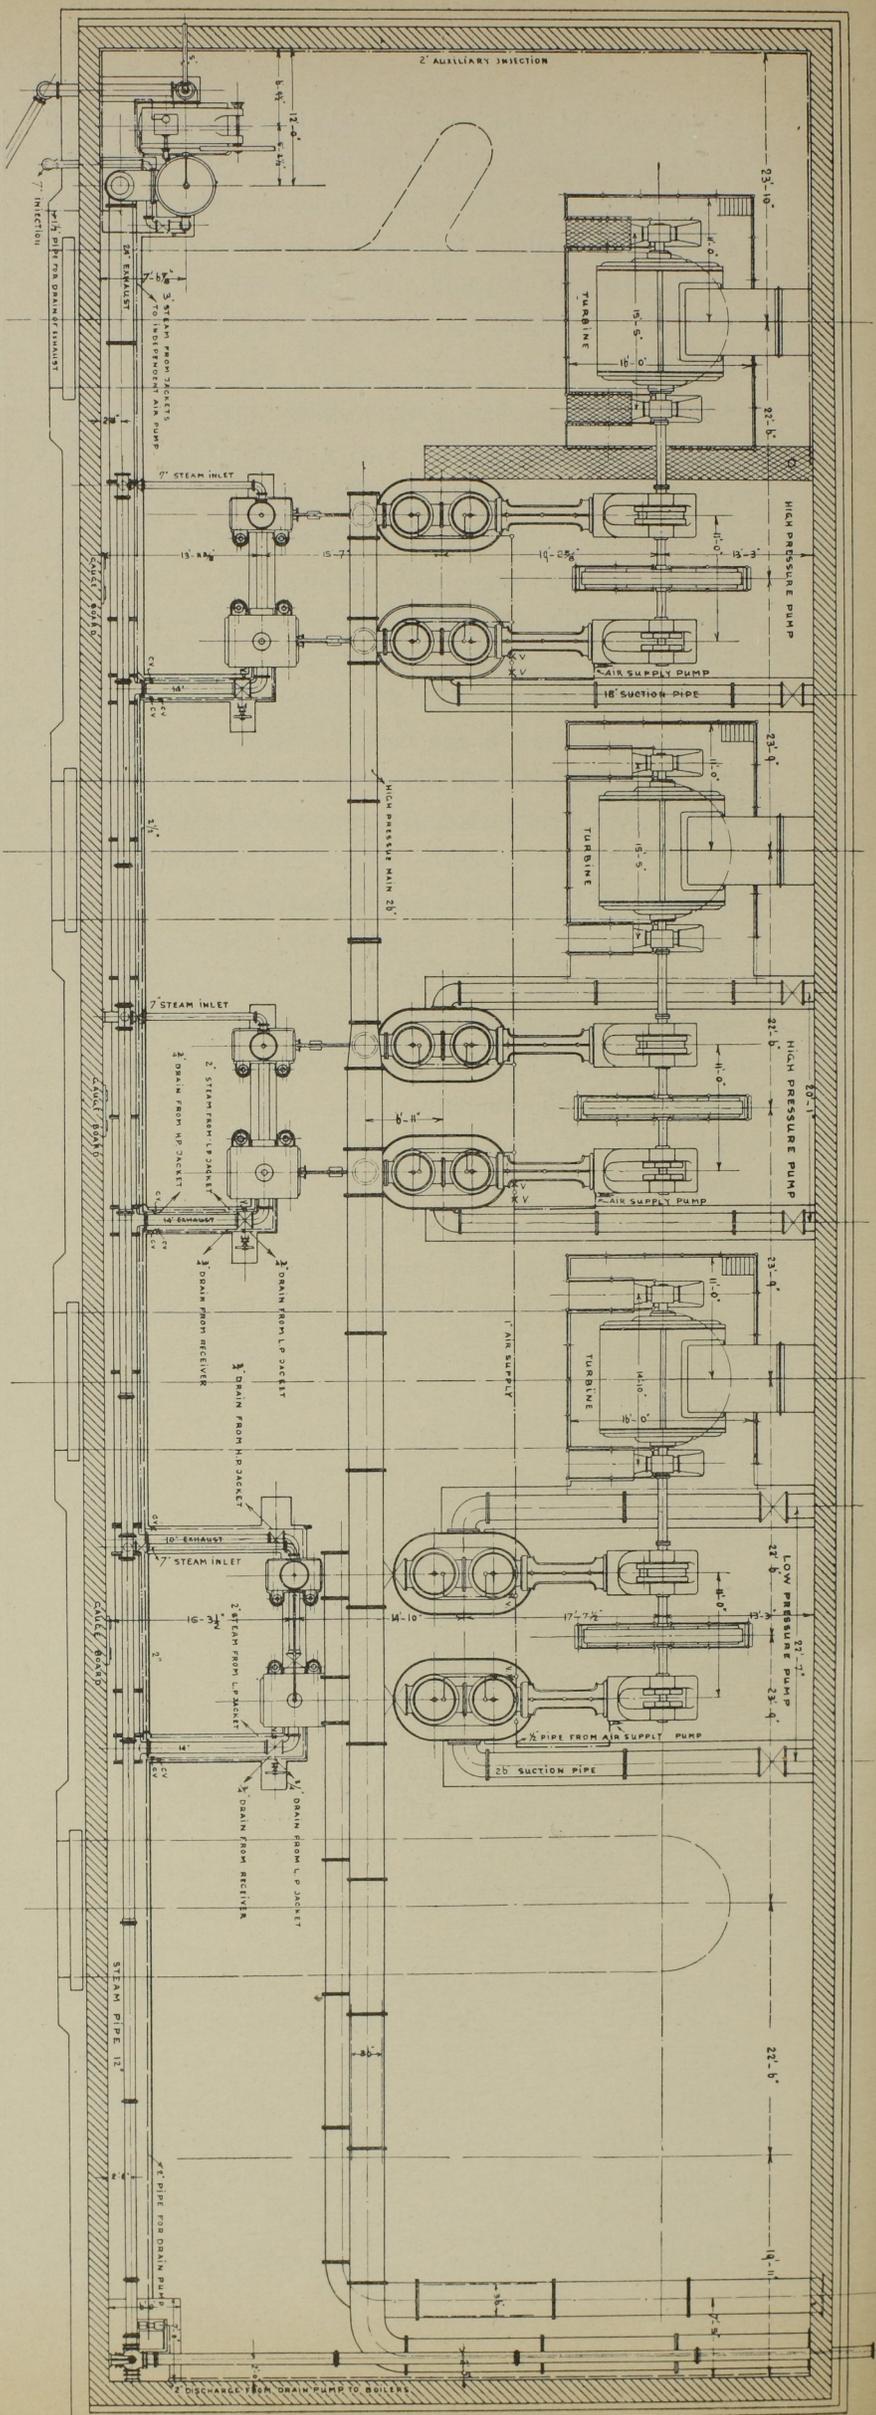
Grundriss. Abb. 175 Aufriss der Gesamtanlage. Massst. 1:200.
